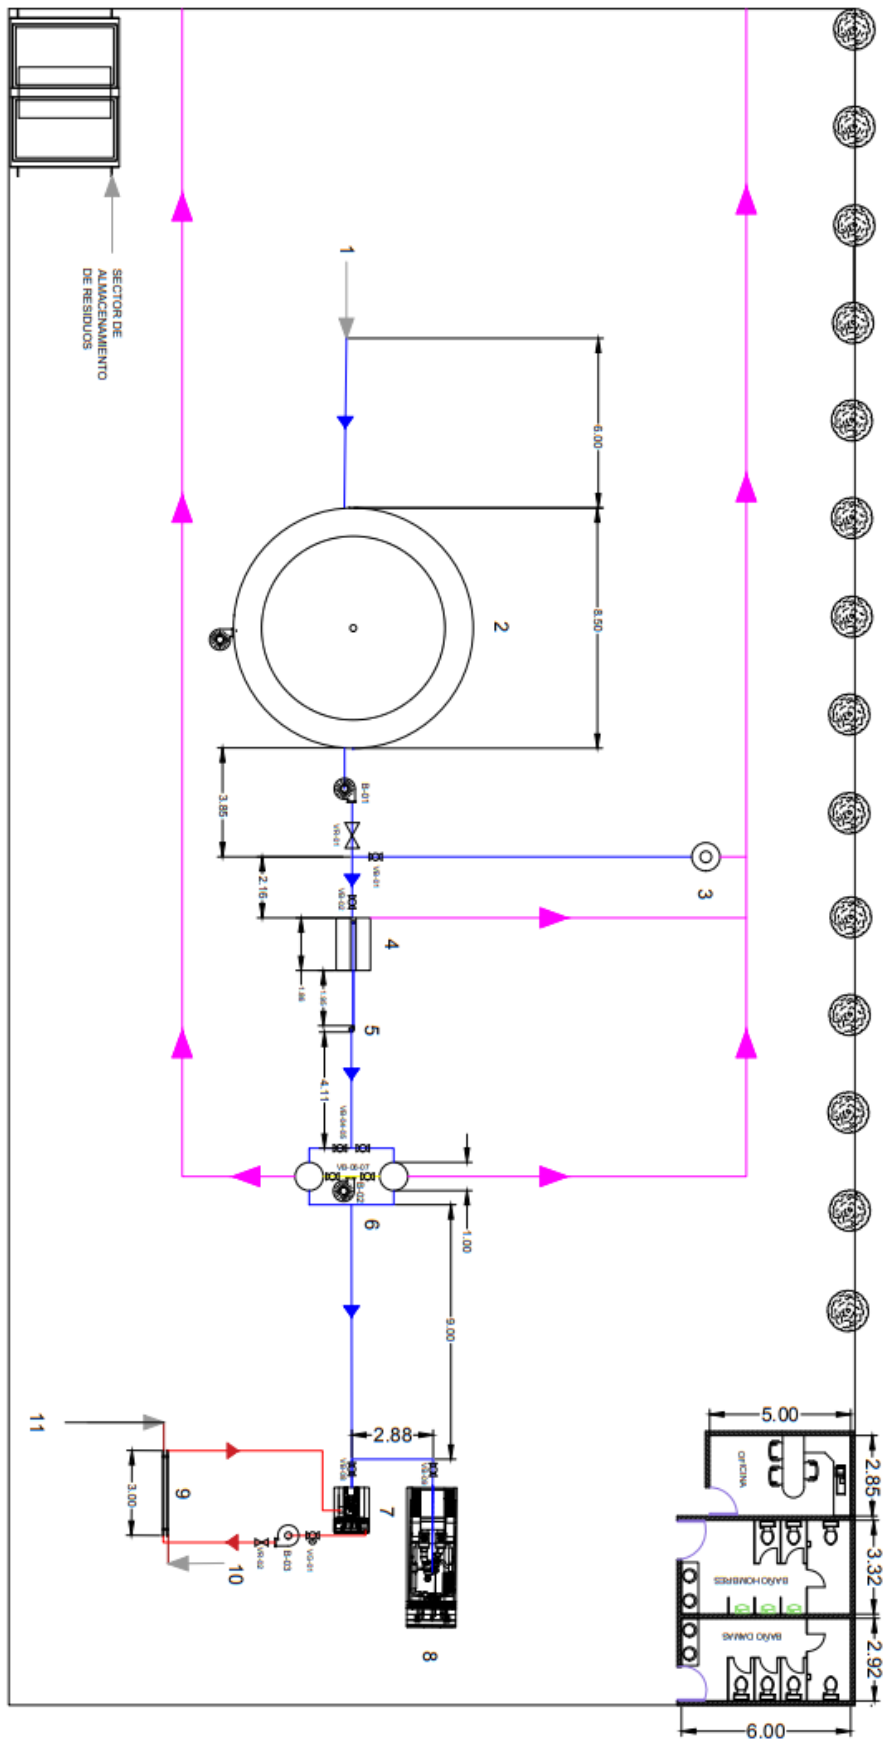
Vista y disposición de equipos y corrientes en la planta
